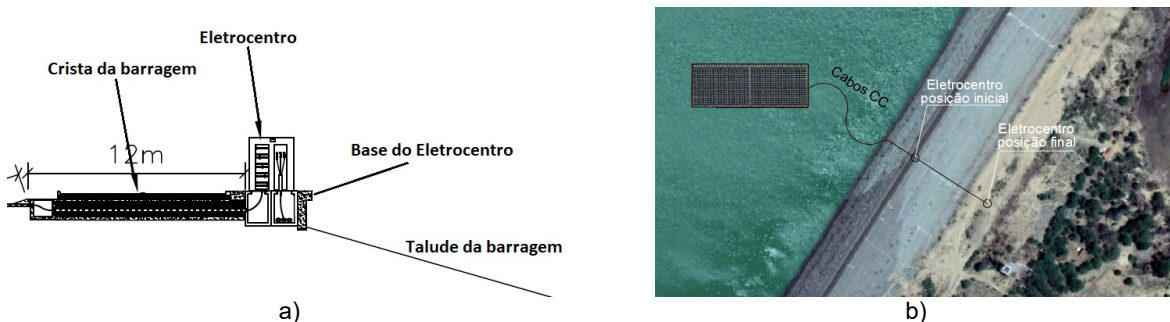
a) Configuração preliminar para instalação do eletrocentro. b) Vista aérea mostrando o ponto inicial e o ponto que se mostrou mais adequado para a instalação do eletrocentro.
